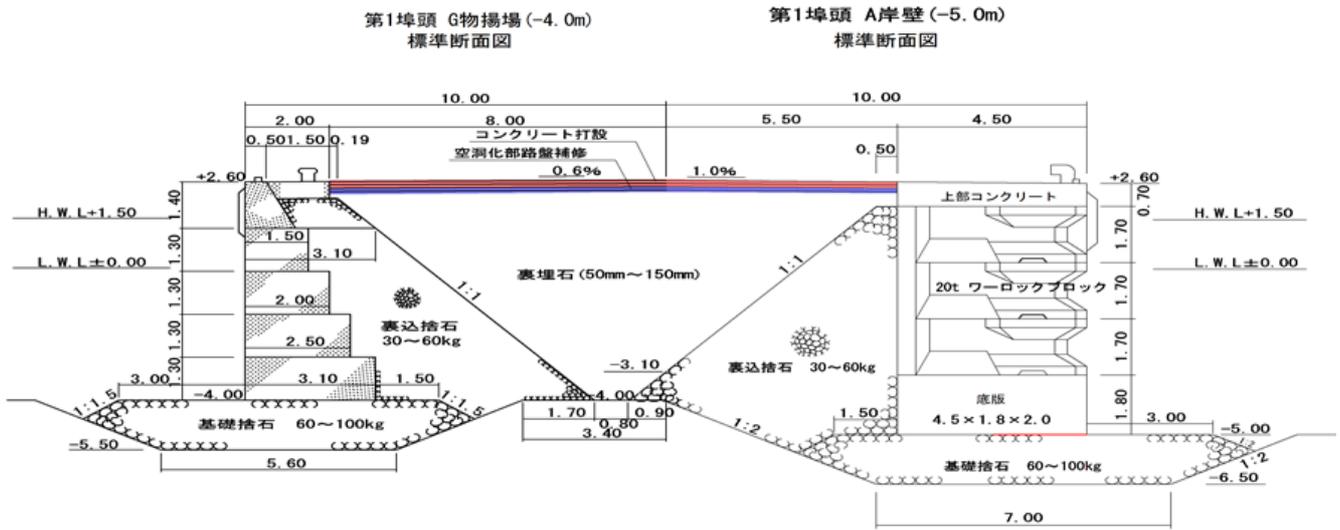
No.27 大洗港区_第1埠頭G物揚場 (-4.0m) (水産ふ頭地区) の断面図 (復旧後)
